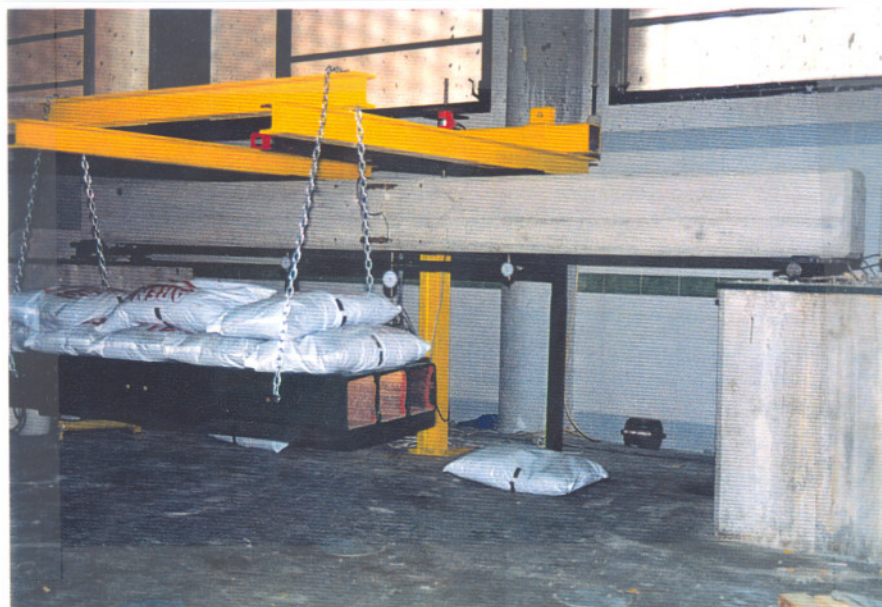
El sistema de carga empleado estaba configurado por un bastidor metálico apoyado sobre la viga, sujeto por un extremo a la losa de carga mediante un tirante y colgando de su otro extremo la carga muerta (sacos de arena).
